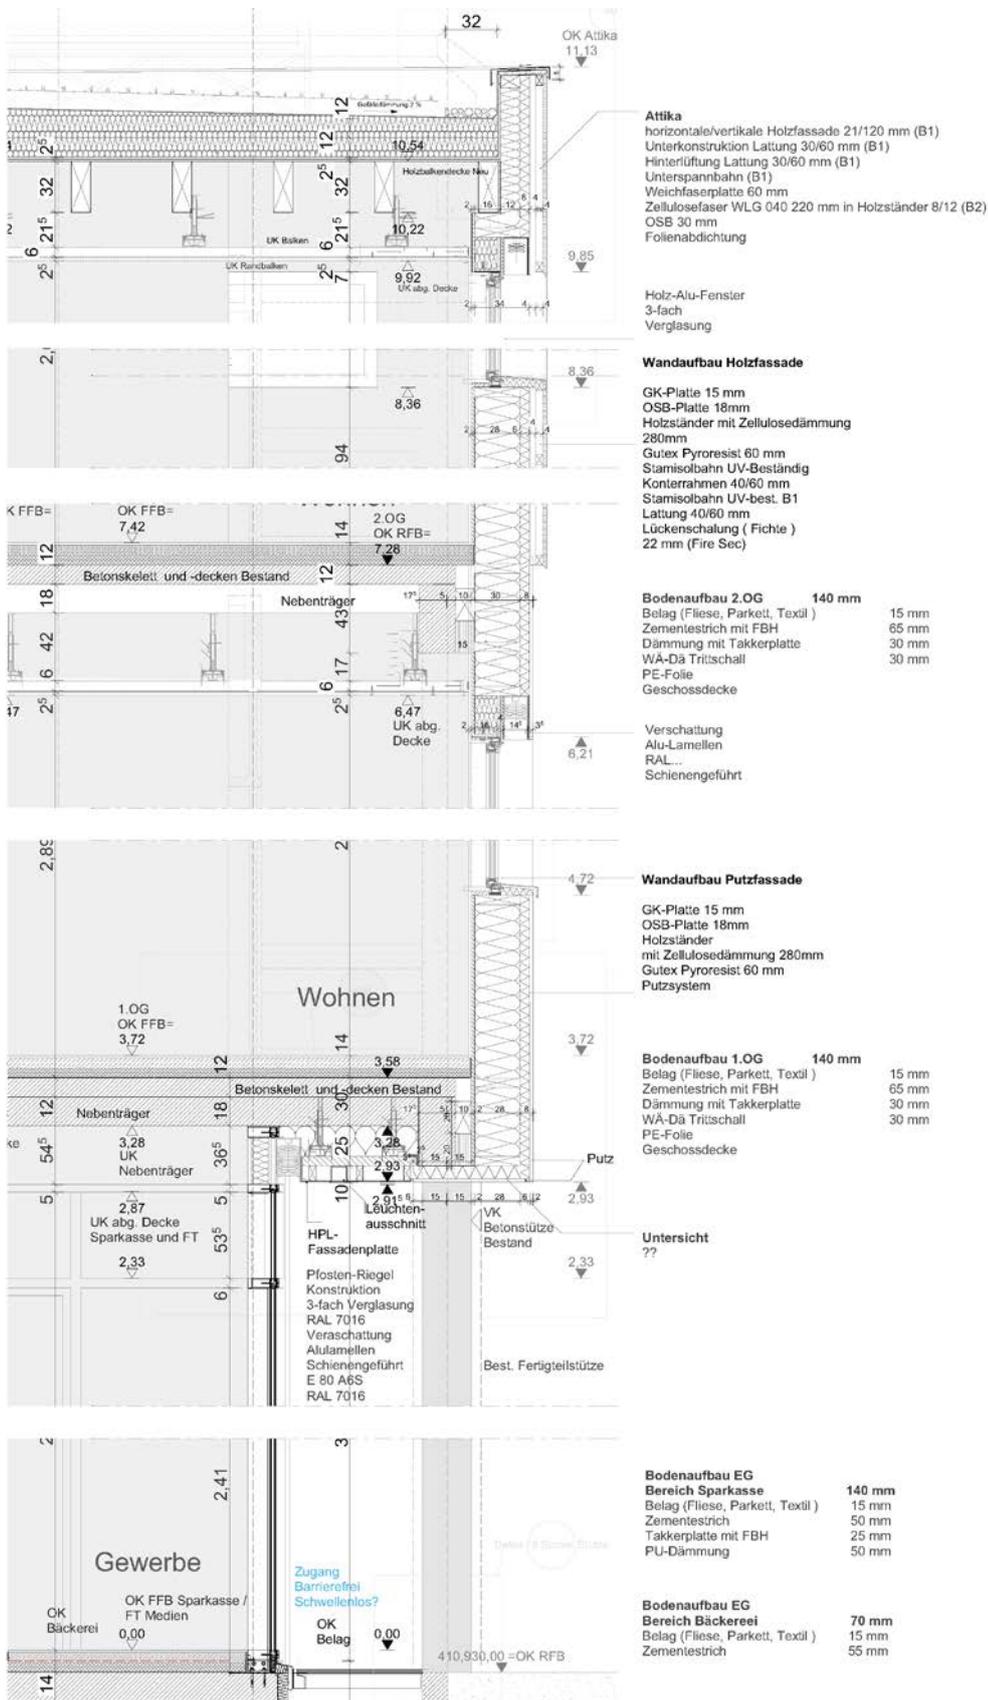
zeigt einen Fassadenschnitt der Sparkasse Kressbronn. Im Schnitt auf der Abbildung 36 ist der Bereich des Fassadenschnitts farbig markiert. Konstruktiv unterscheidet sich der Fassadenaufbau der Sparkasse vom Aufbau des Energiewendemoduls nicht. Die Fassade wurde so entworfen, dass sie bis zur Attika des Energiewendemoduls reicht. Lediglich die Holzfassade trennt optisch das Energiewendemodul von der Sparkasse. Die Fassade ist durch Unterzüge am Bestandsgebäude verbunden, sodass sie hängt.
